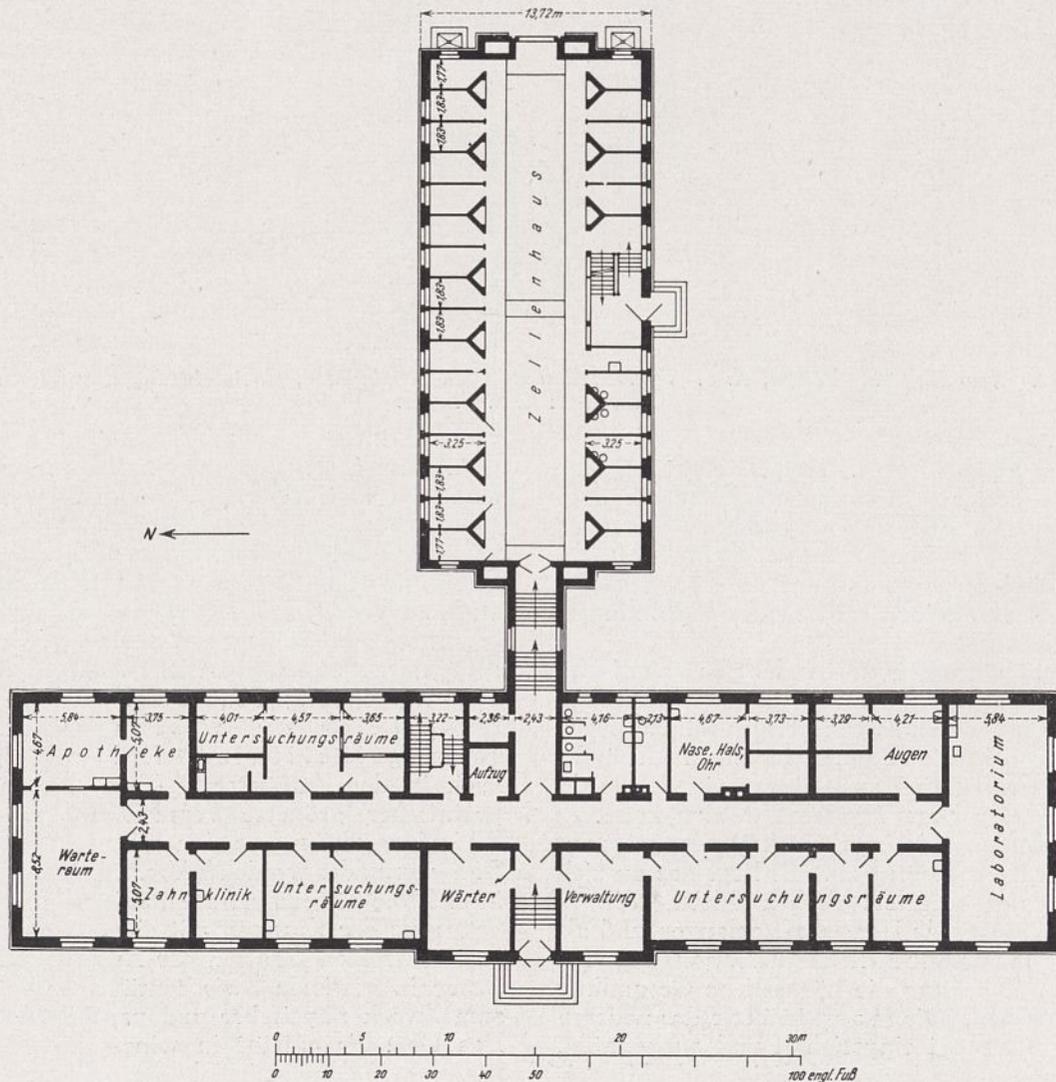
New Sing Sing Prison, N. Y. Klinikgebäude. Grundriß des Hauptgeschosses. Architekt: E. F. Pilcher.
